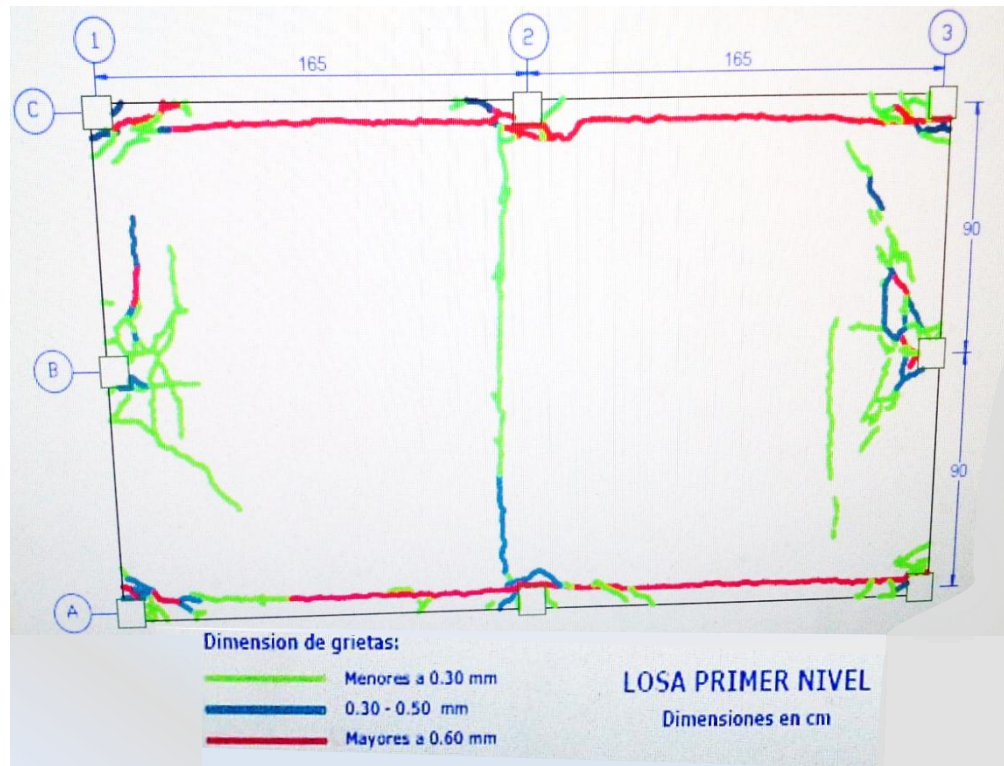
d2-2) Esquema e imagen de ensayo de espécimen de losa armada ante carga lateral. Véase la formación de grietas longitudinales por flexión principalmente, paralelas a bordes y ejes
